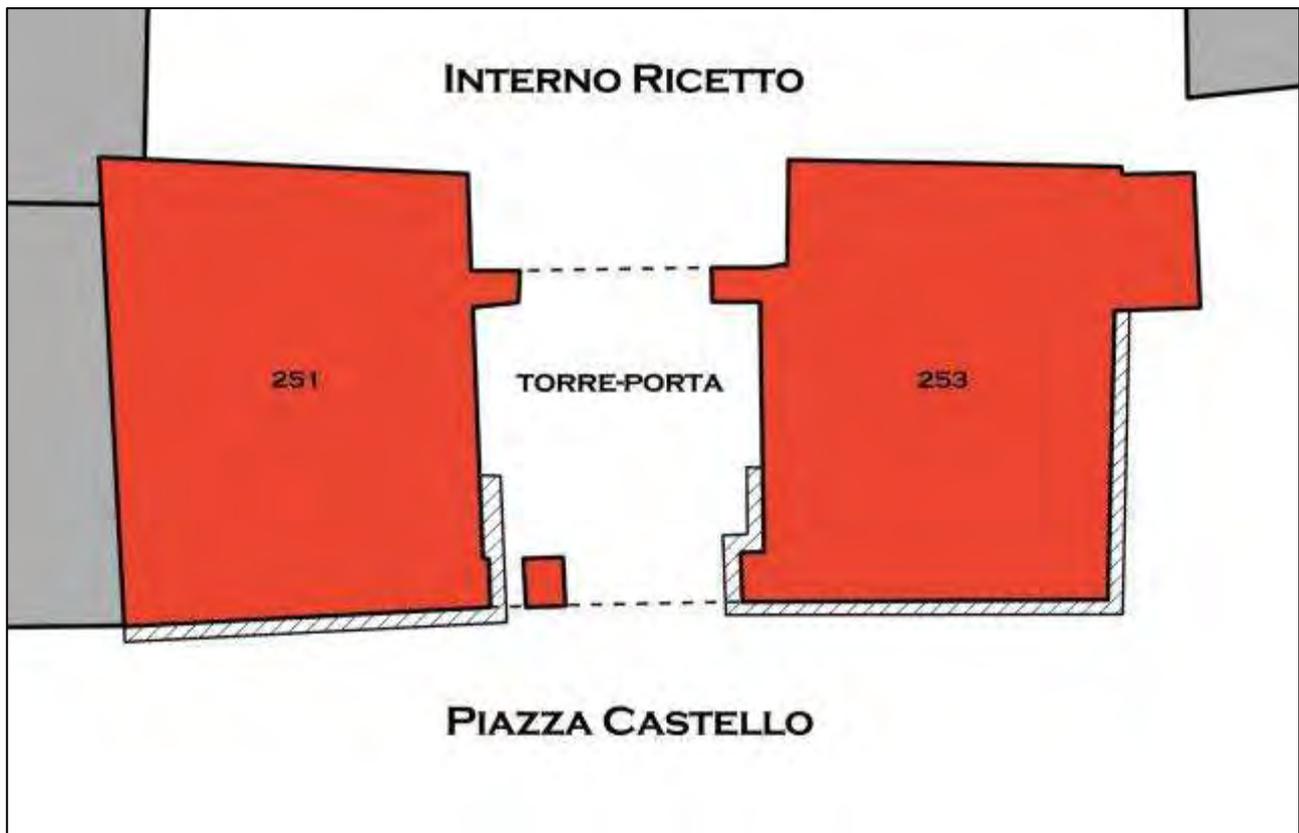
Candelo, Ricetto, planimetria schematica con tratteggiata l'area oggetto delle indagini del 2007.
